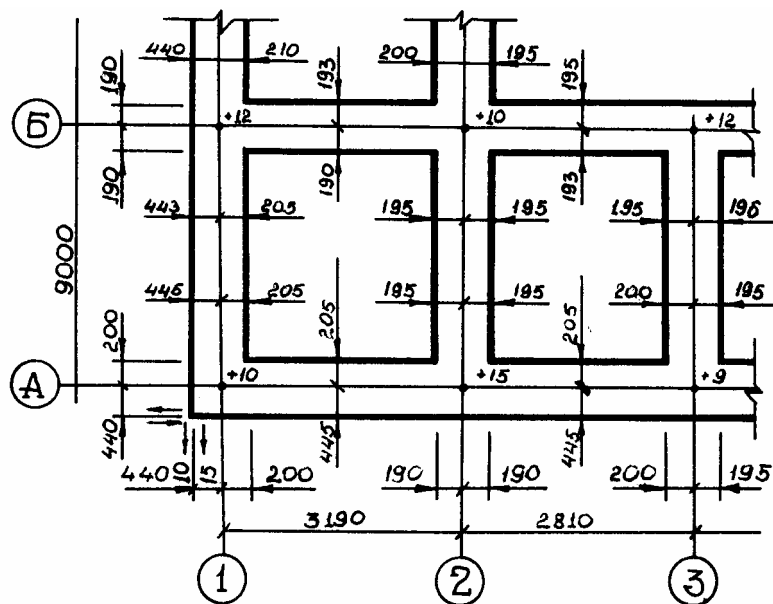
Фрагмент исполнительной схемы кирпичной кладки под перекрытие этажа
